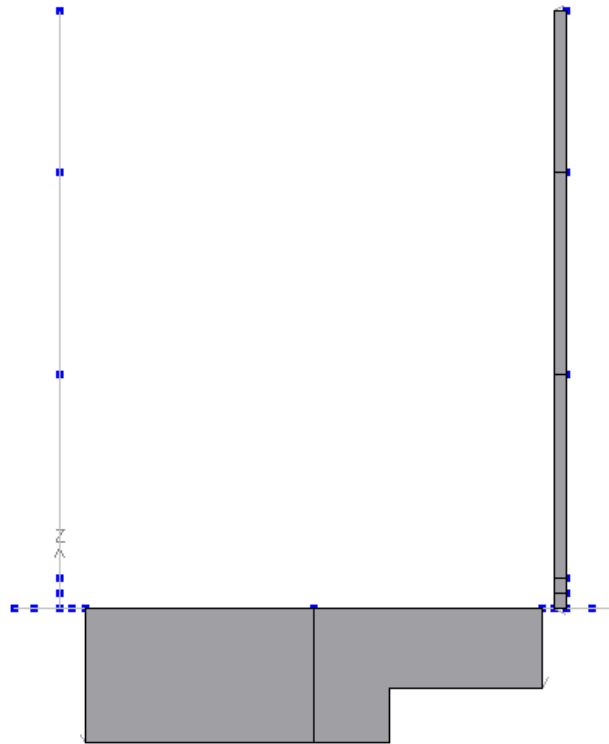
Spinta del sovraccarico 20 kN/m² sul piedritto destro e Sovraccarico accidentale sulla soletta di Fondazione (CDC 13)
